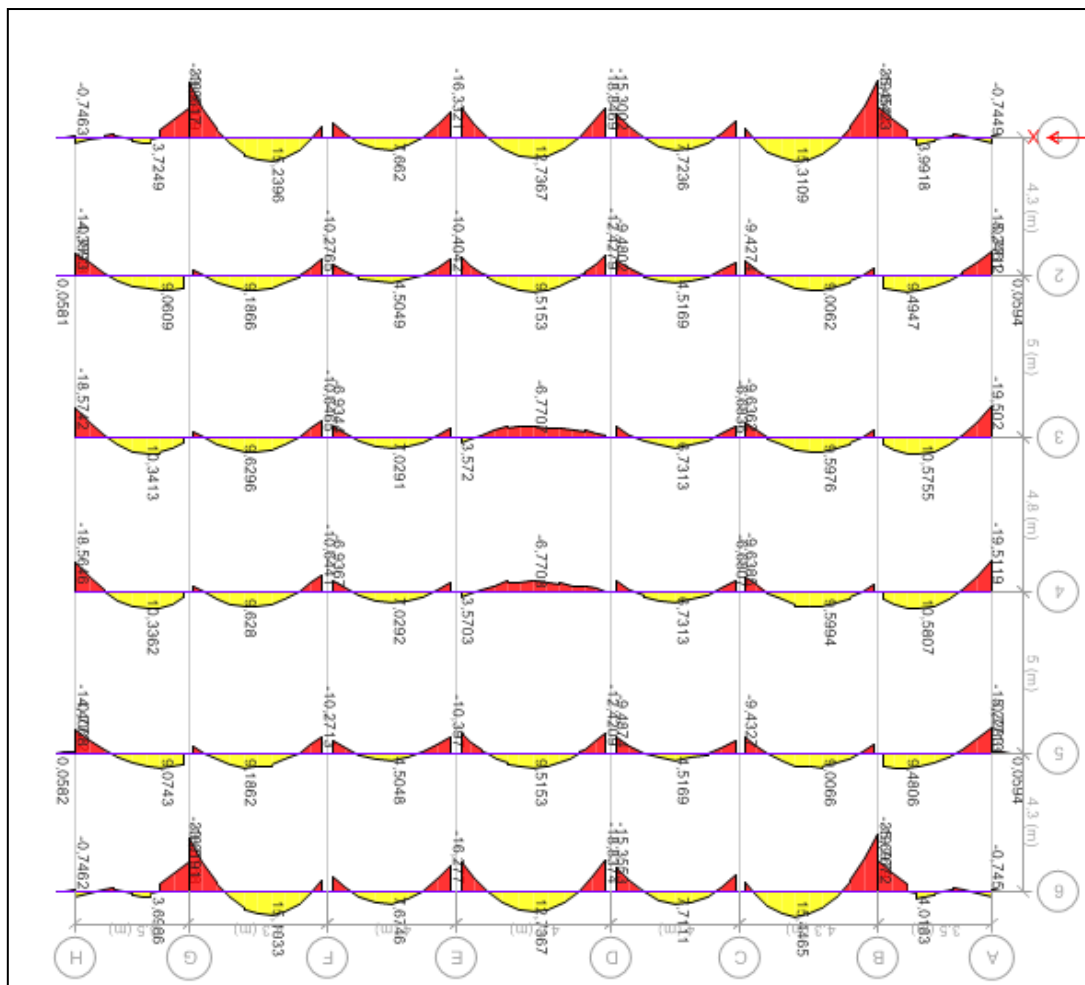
Moment fléchissant des poutres secondaires(ELS)
